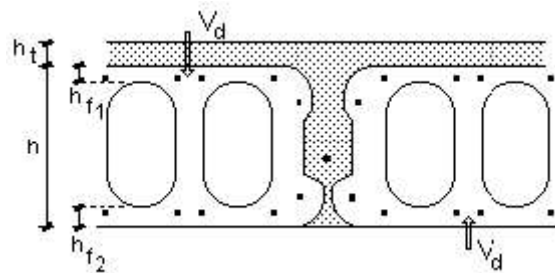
d Esfuerzo cortante en las juntas entre losas alveolares
